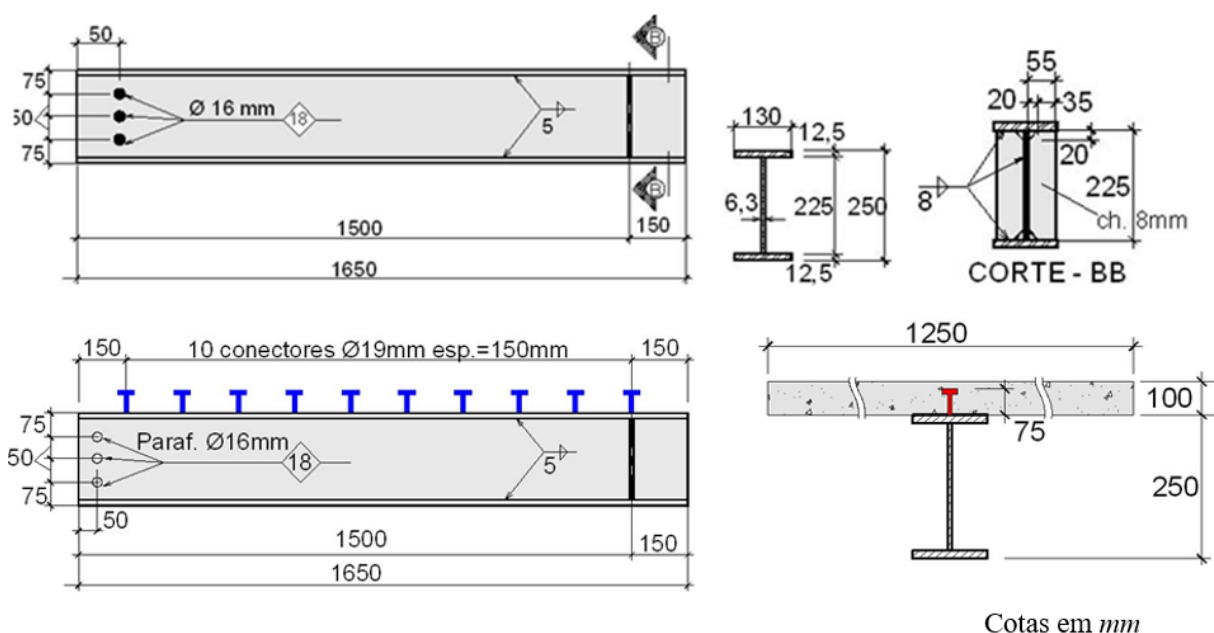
Detalhes da viga mista (DE NARDIN, 2007)
